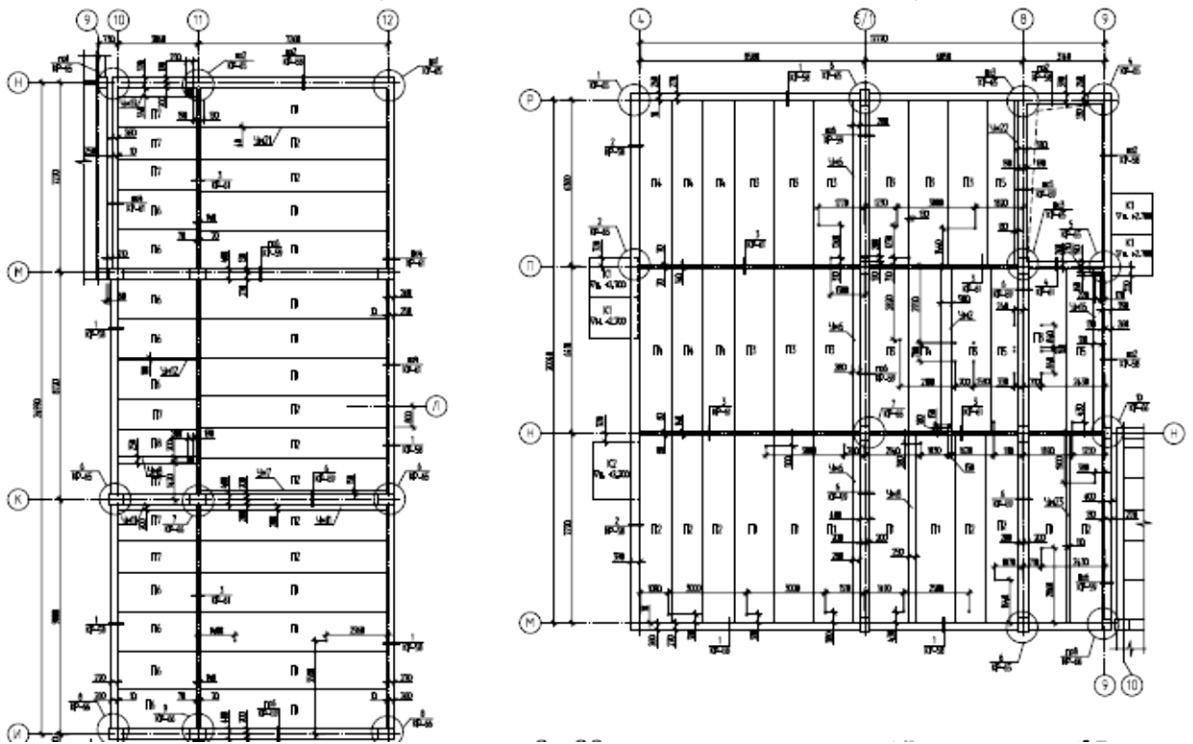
Схема расположения плит перекрытия и антисейсмического пояса на отм. + 3,000 в осях И-Н, 10-12; М-Р 4-9
